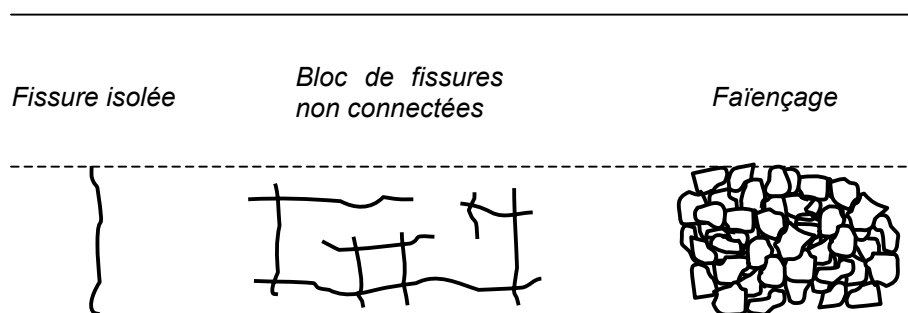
Différents chemins de fissuration (vue de haut de la chaussée)
